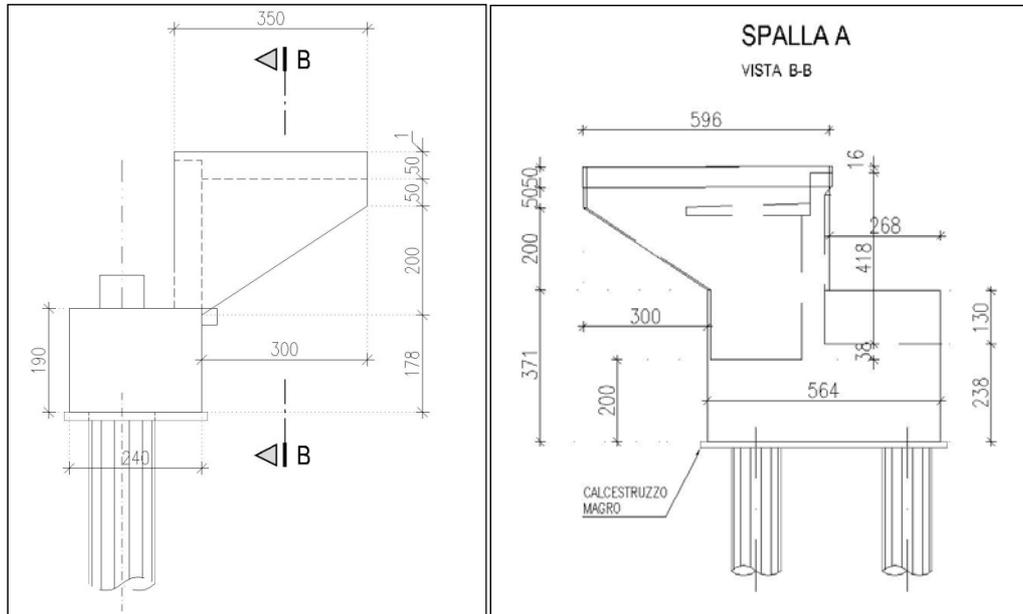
SEZIONI TIPICHE DELLE SPALLE PASSANTI
